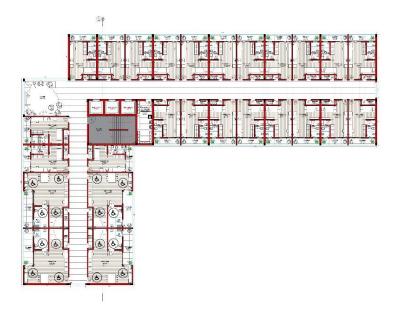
Planta baixa do Bloco A – Pavimento TIPO.
